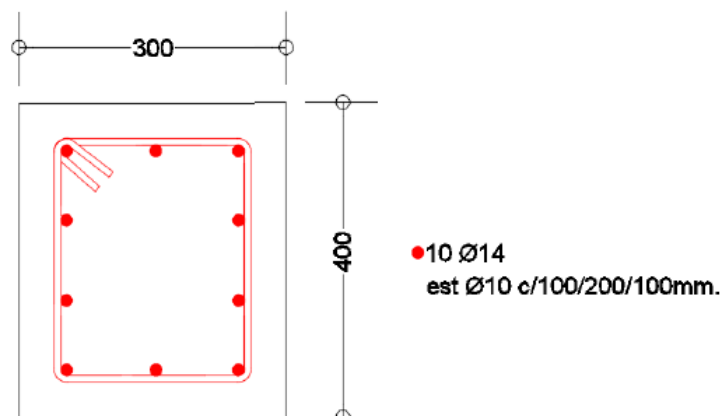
Armado general de Columnas de Fachada. Fuente: (Loor, 2015)
